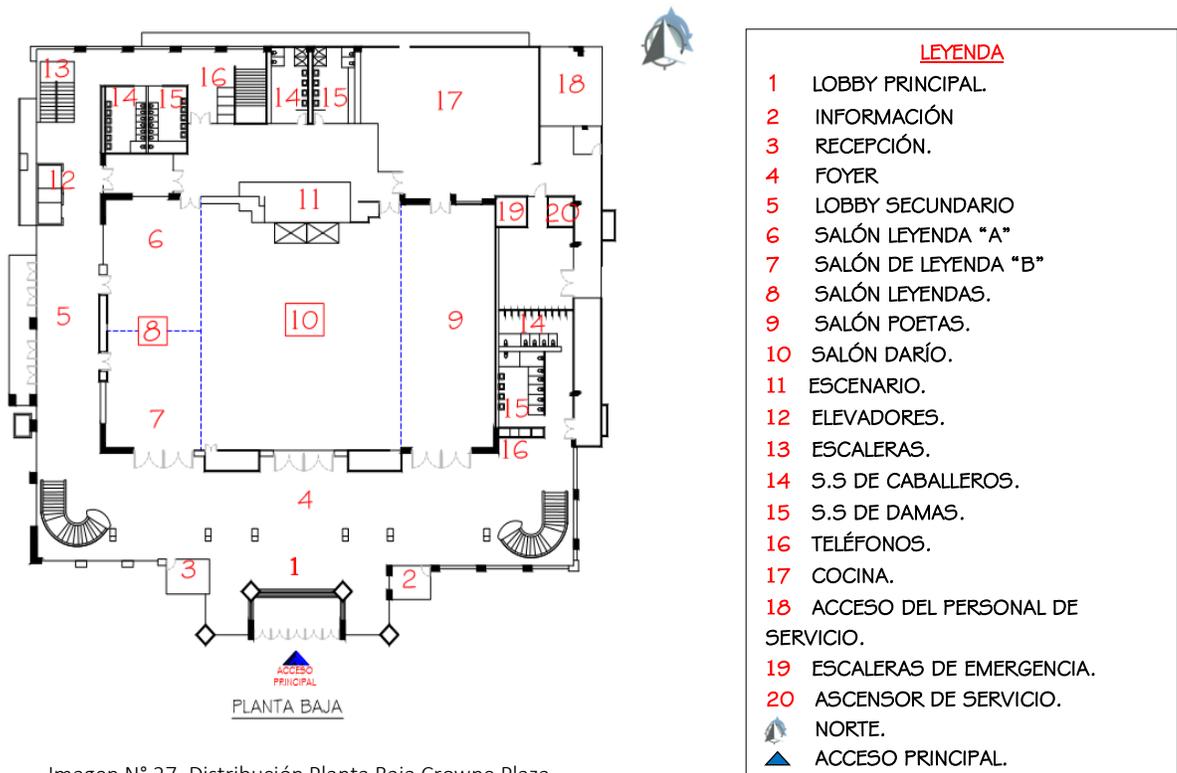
Distribución Planta Baja Crowne Plaza
